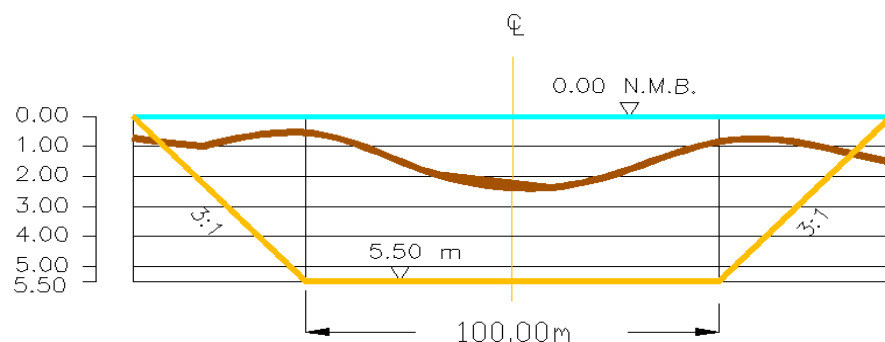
Sección tipo de un canal de 100 m. a dragar.
